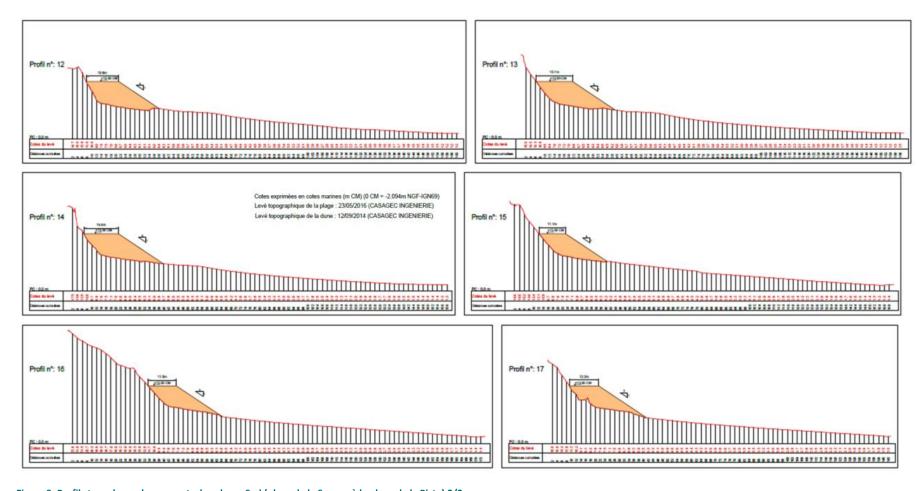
Profils type des rechargements des plages Sud (plage de la Savane à la plage de la Piste) 2/2.
